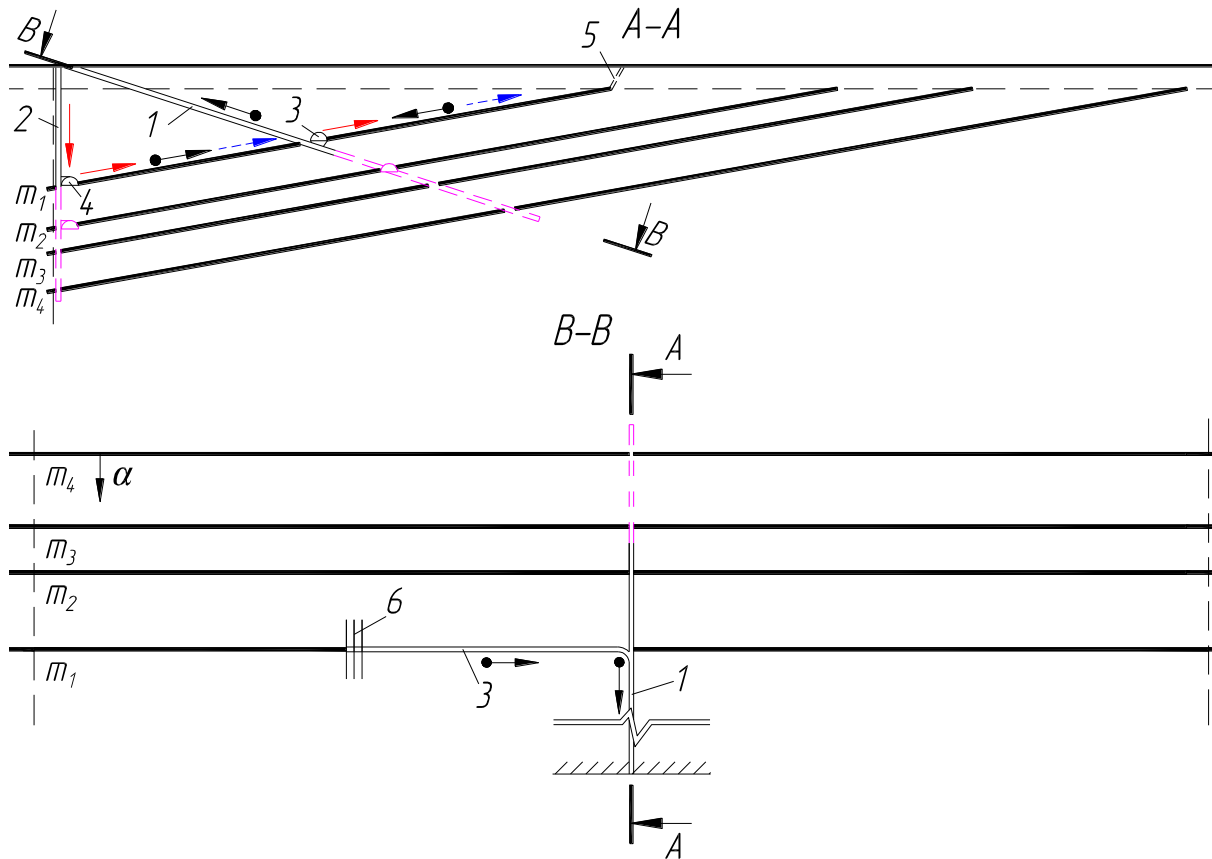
Комбинированное вскрытие без дополнительной вскрывающей выработки с проведением наклонного ствола вкрест линии падения:
